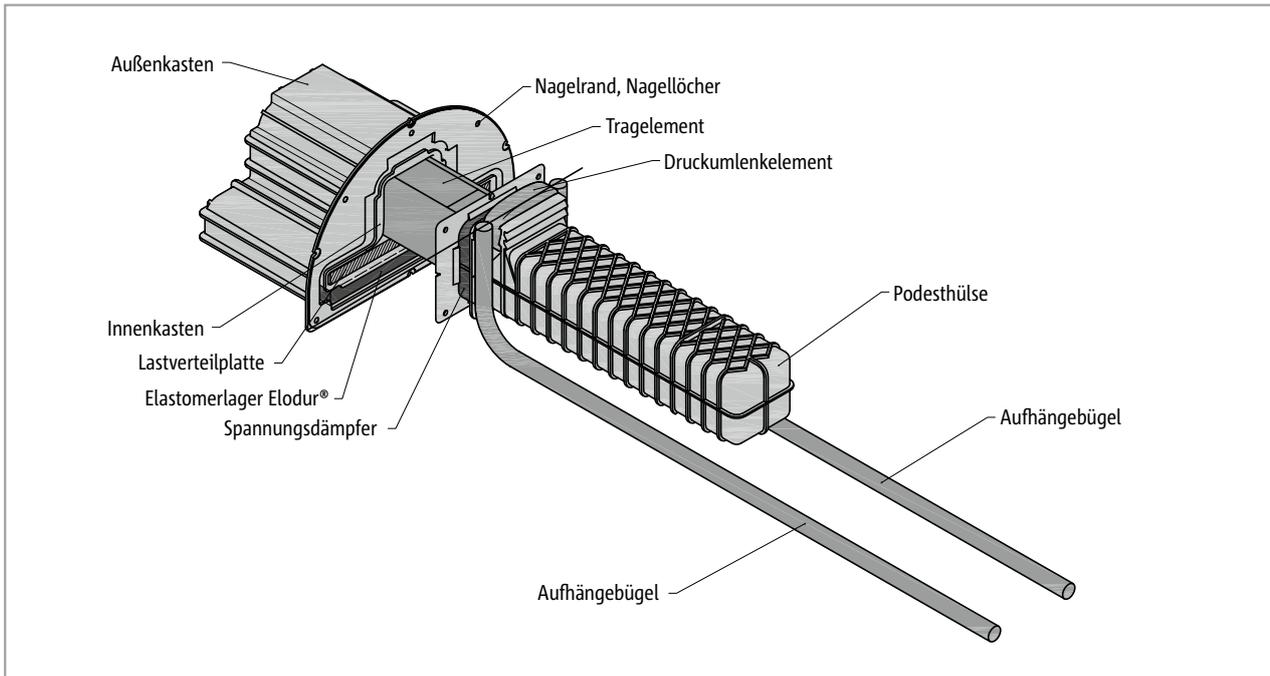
Schöck Tronsole® Typ P: Wandelement, Tragelement und Podesthülse mit detaillierter Benennung wichtiger Bestandteile
